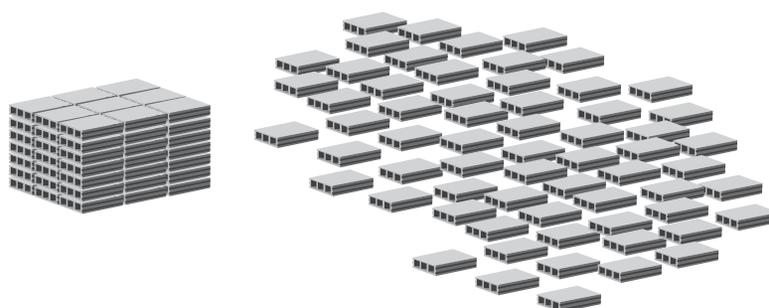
Tijolos espalhados x tijolos empilhados.
